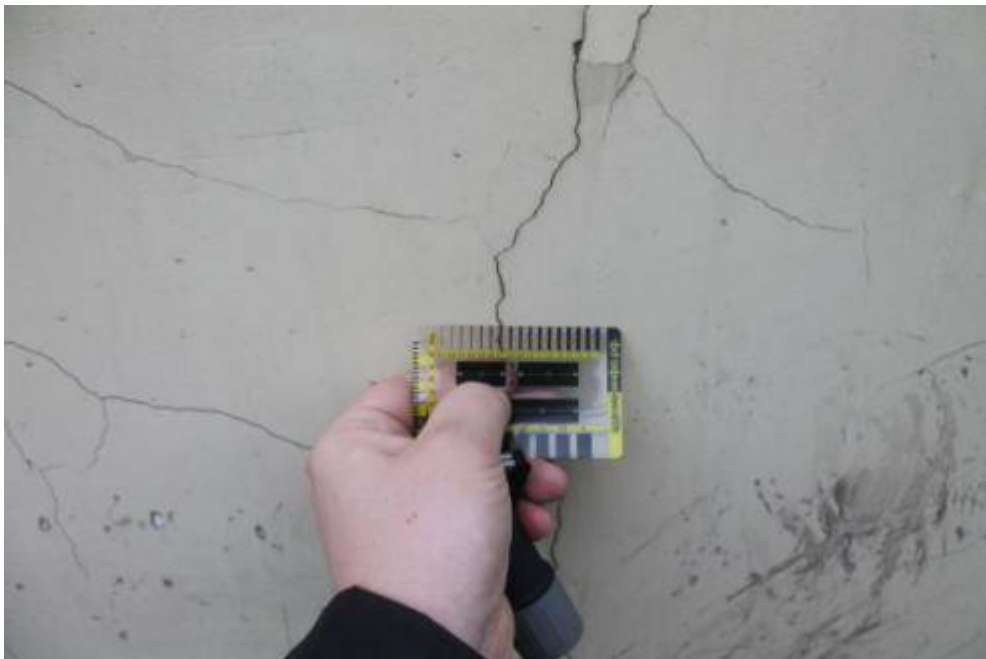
Система трещин во внешней фасадной системы. Измеряемая трещина имеет ширину 0.5 мм, фасад по оси "А".
